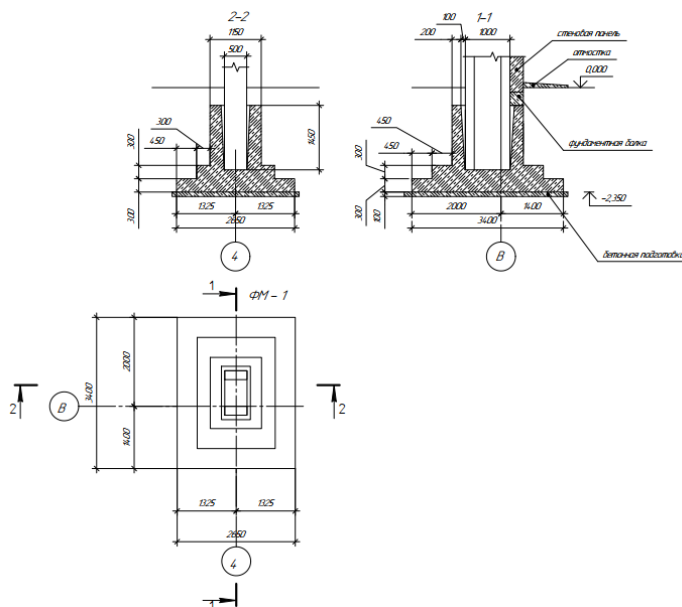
Фундамент крайнего ряда ФМ – 1
